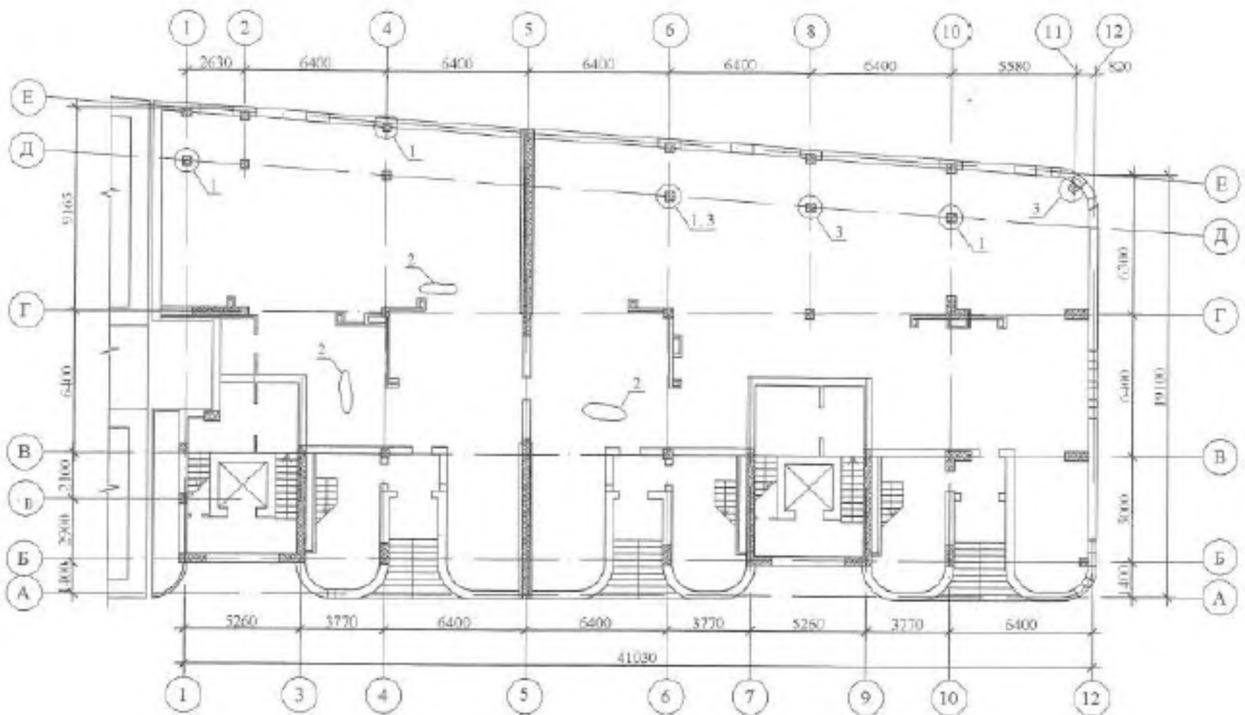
План 1-го поверху на відм. 0.000. Відновлення конструкції каркасу
